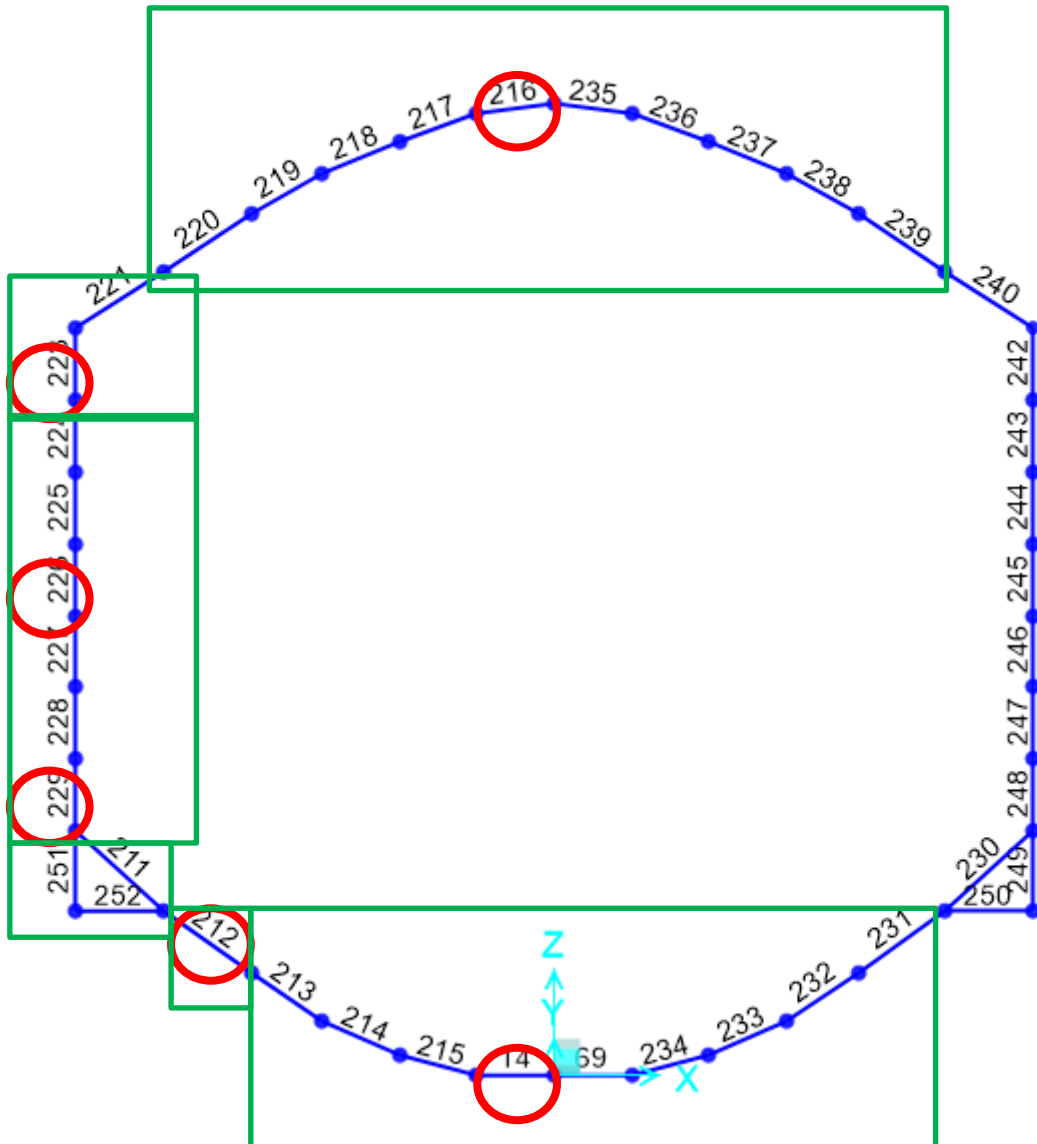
Sezione 1 – Concio d'attacco – imbocco lato East
